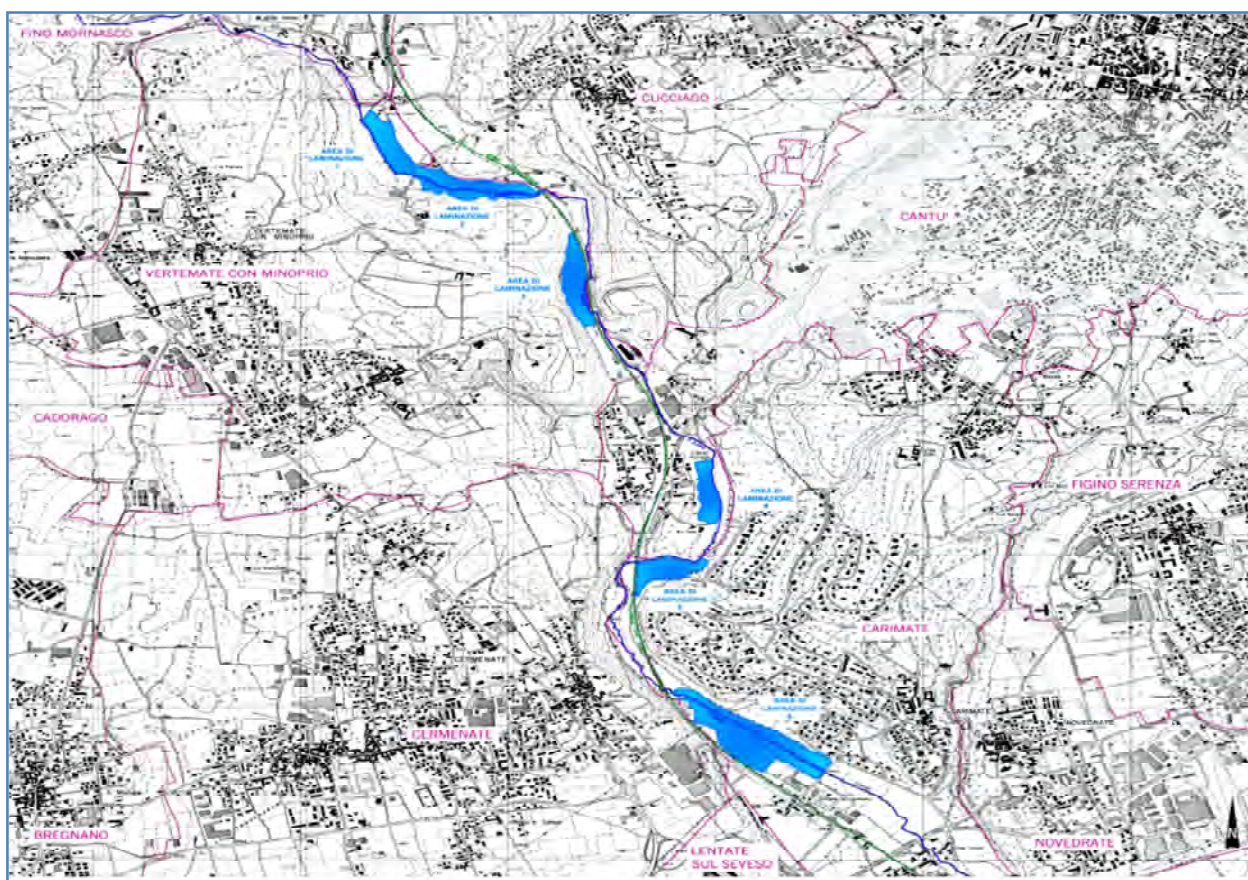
STRALCIO PLANIMETRIA PROGETTO PRELIMINARE
